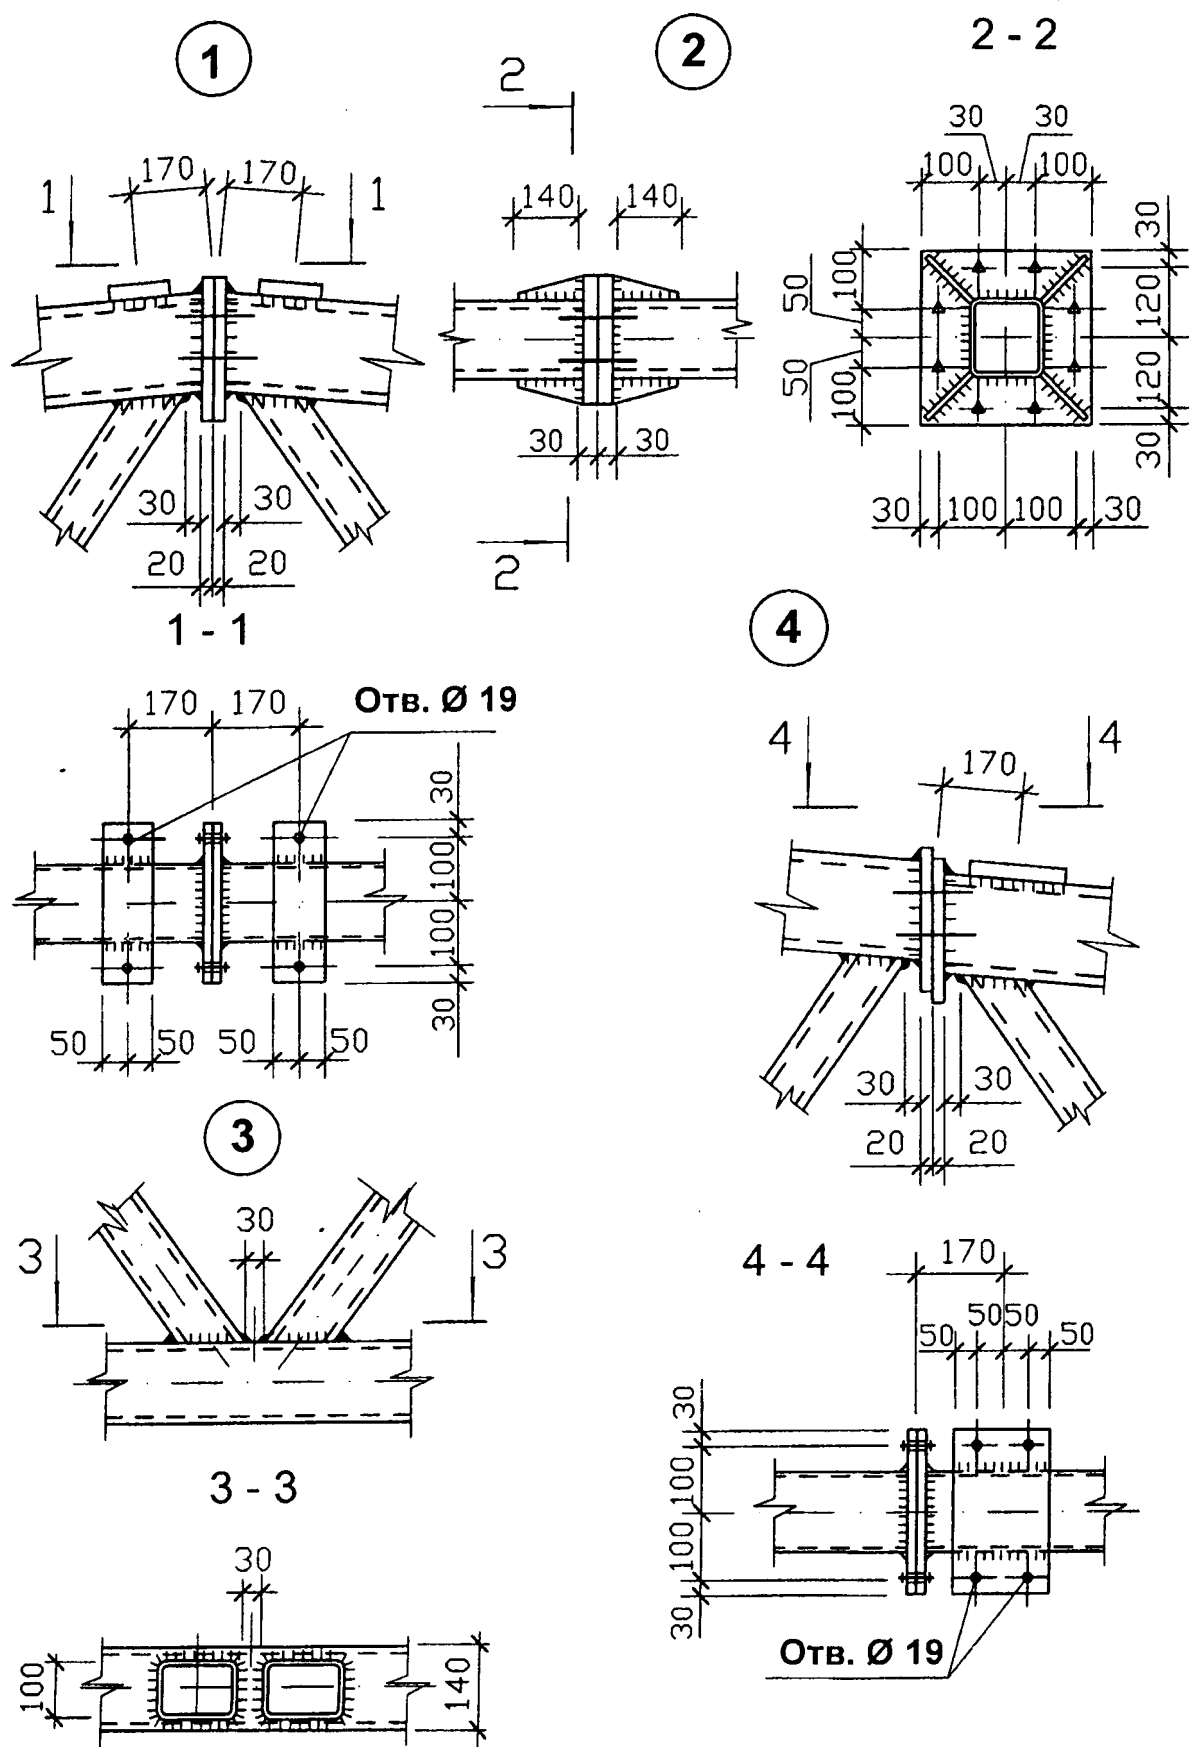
Узлы стропильной и подстропильной ферм покрытия по серии 1.460.3-23.98
